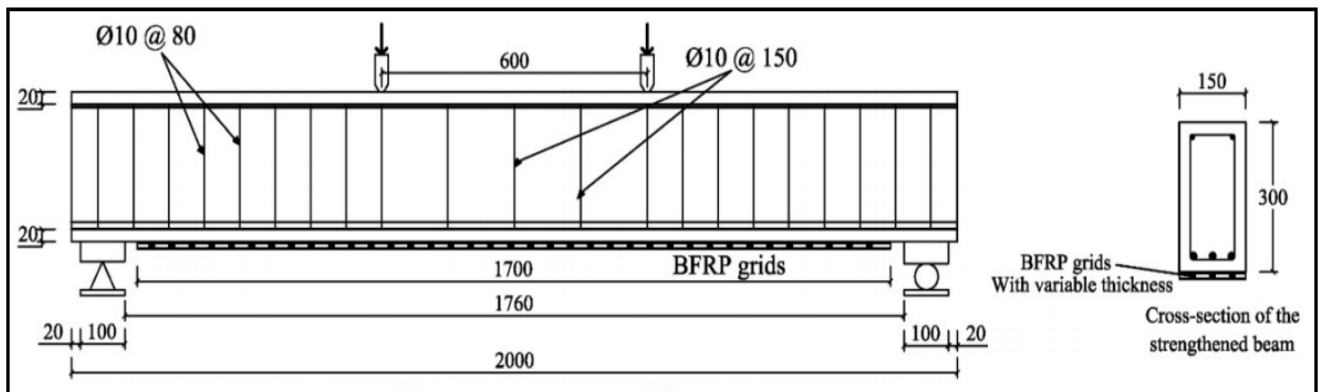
Détail du renforcement des poutres testées [Ali, N. M. et al 2015].
